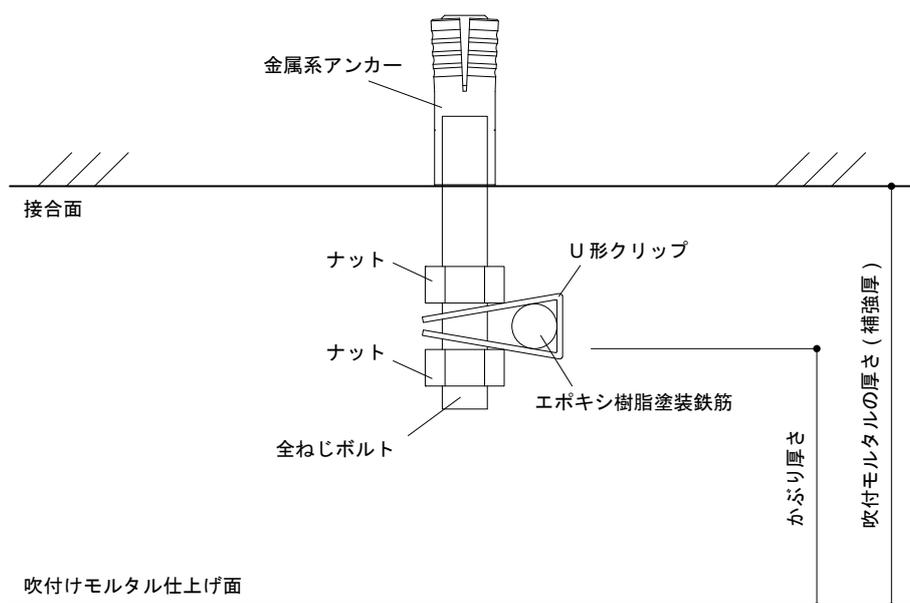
あと施工アンカーの施工例 (金属系アンカーの場合)
